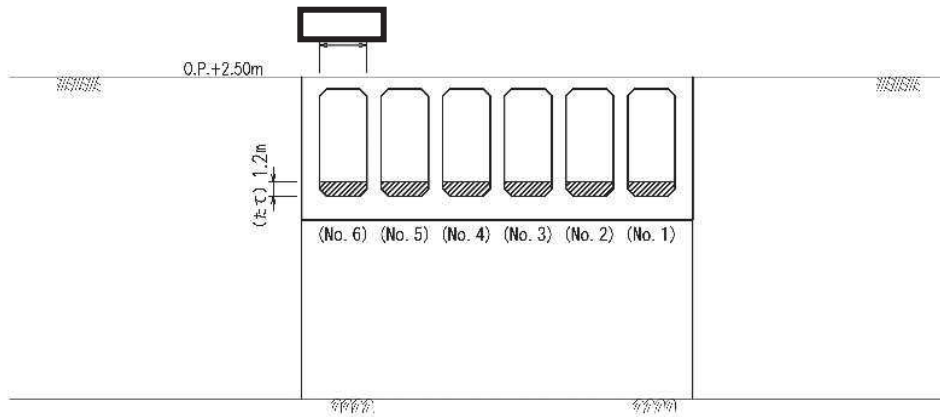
貯留堰（取水口）断面図（A-A）
